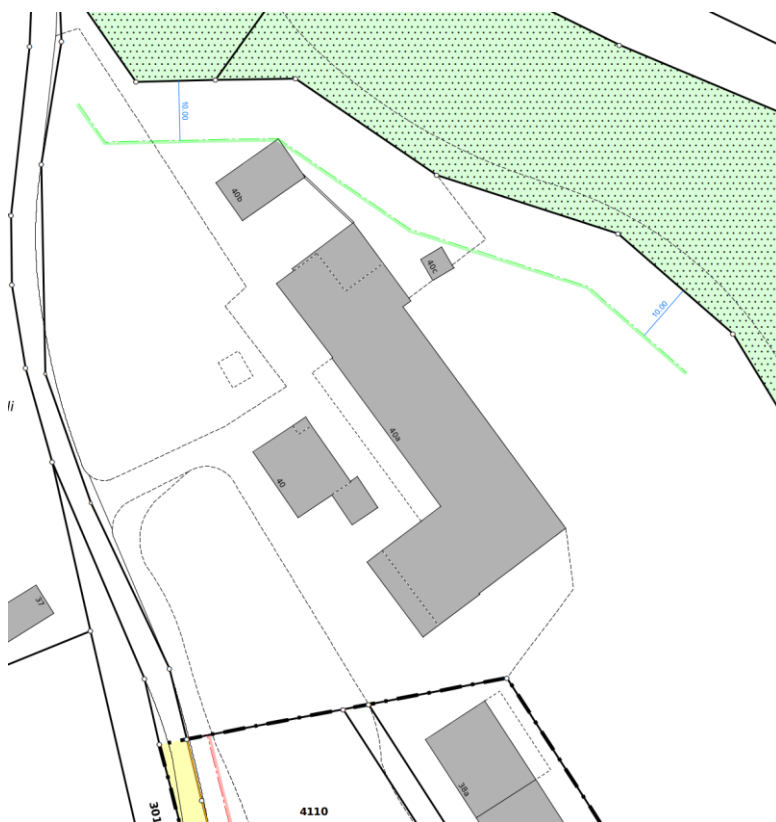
Ausschnitt Revisionsplan (Jermann AG)
